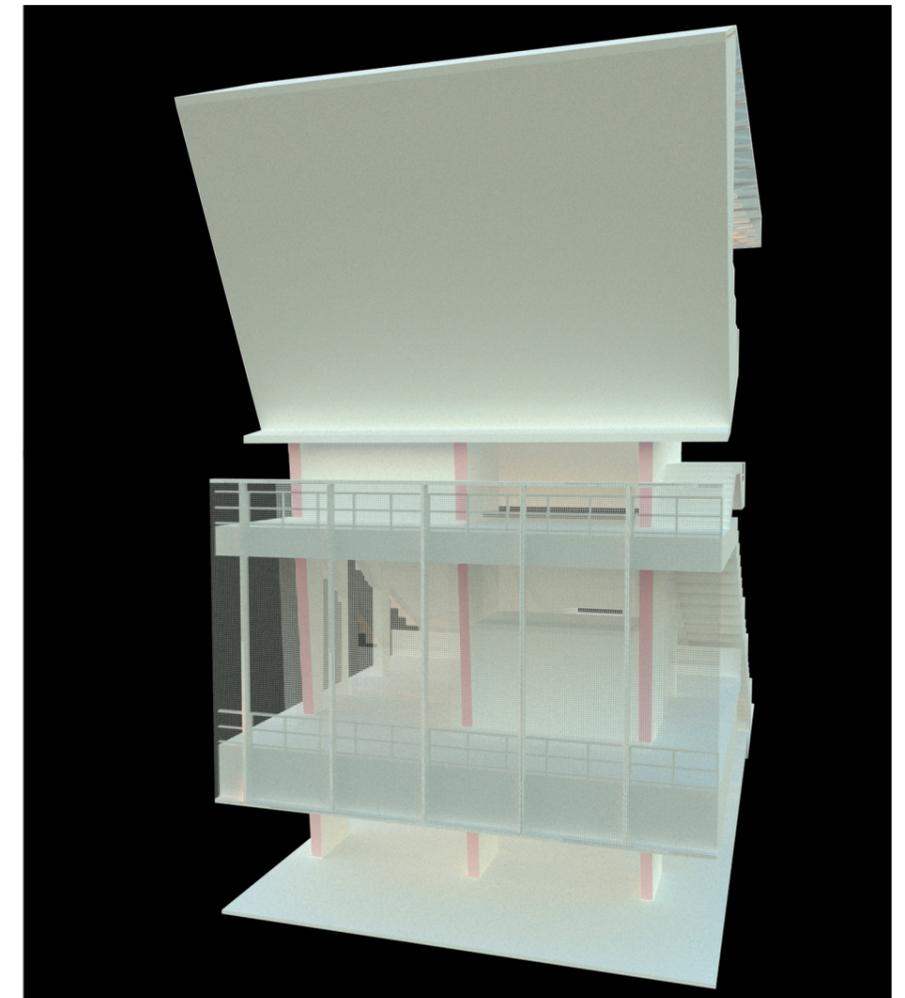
Detalle de la estructura en la fachada de la propuesta. Elaboración propia.
